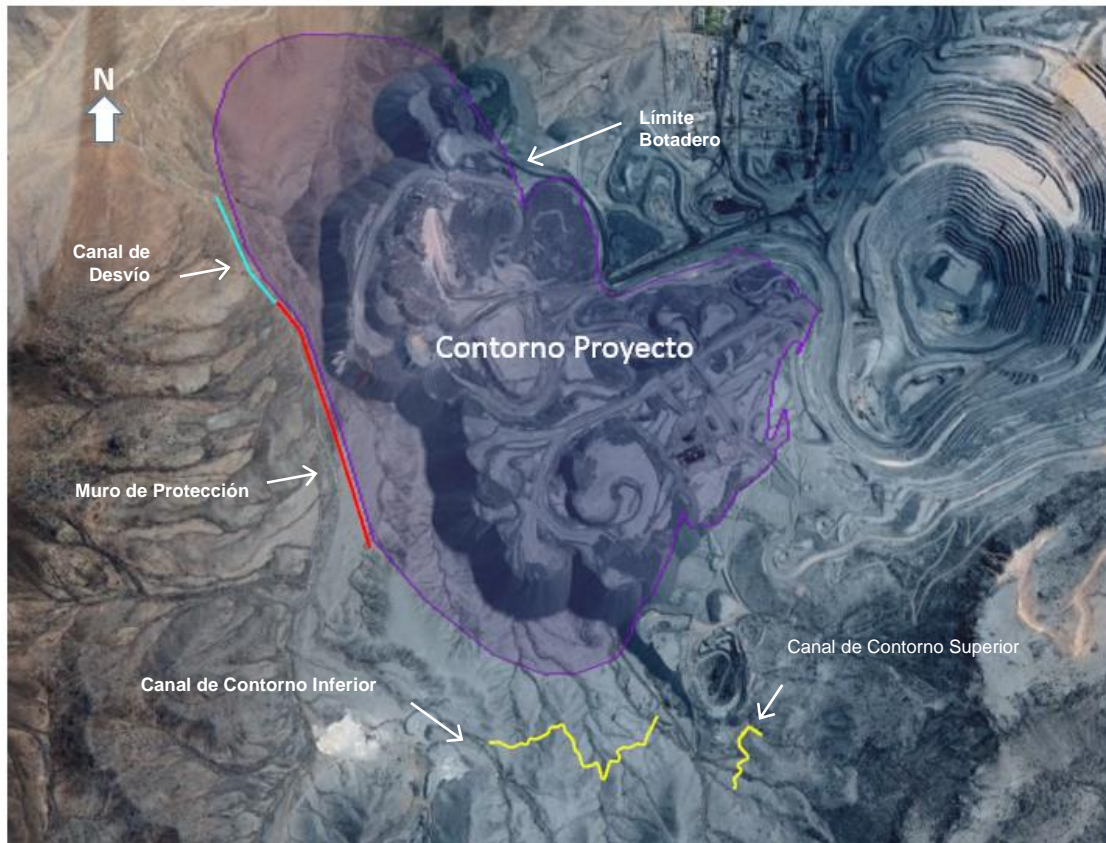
Obras de Drenaje y Protección Fluvial – Mina los Colorados
